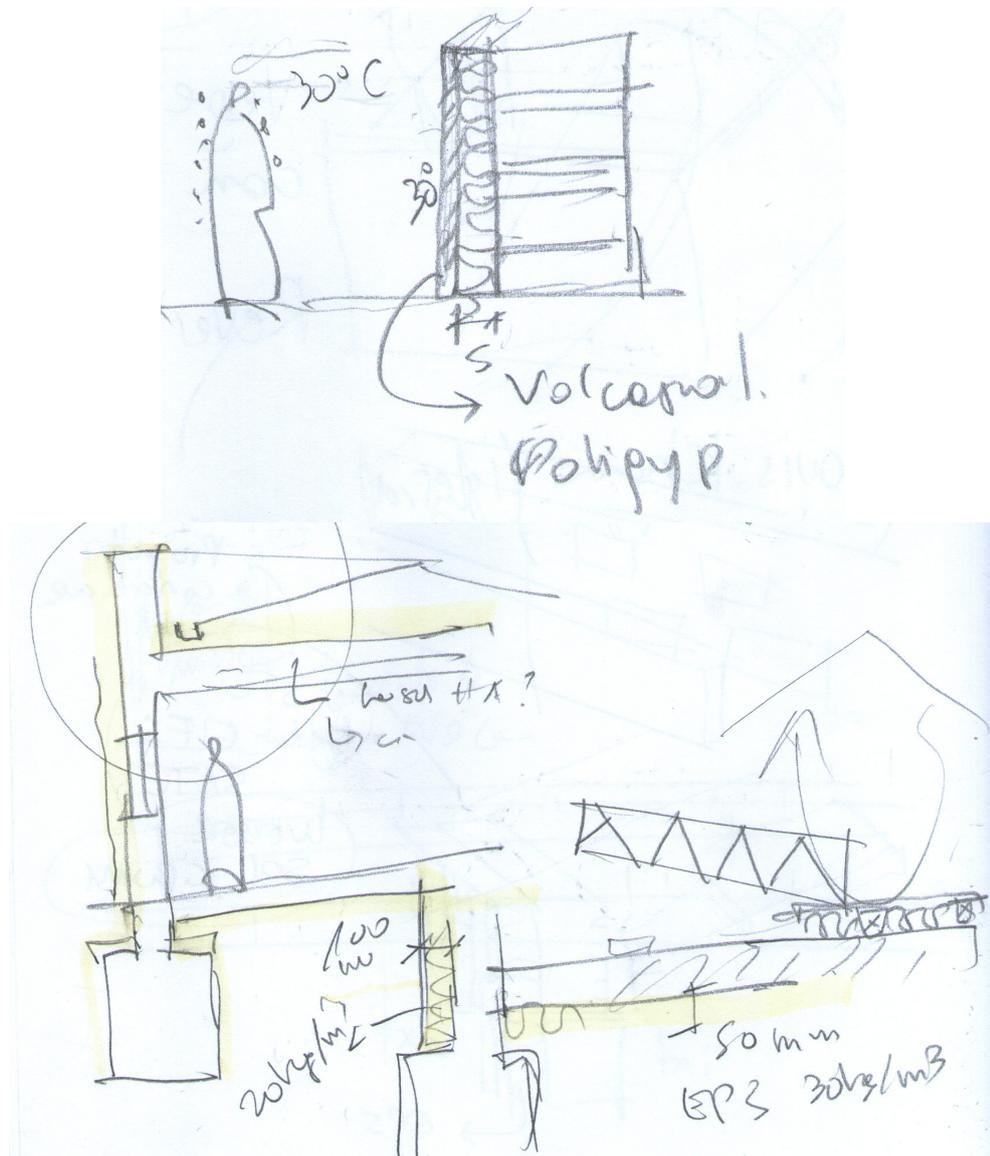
Esquemas de aislación exploratorios para muros y techo. (Elaboración propia)
